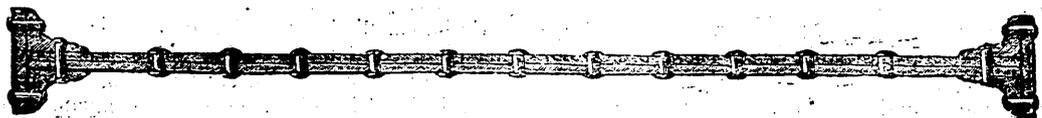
ª—Corte trasversal de una viga del puente sobre el canal de Escant.—Escala de 0.10.
